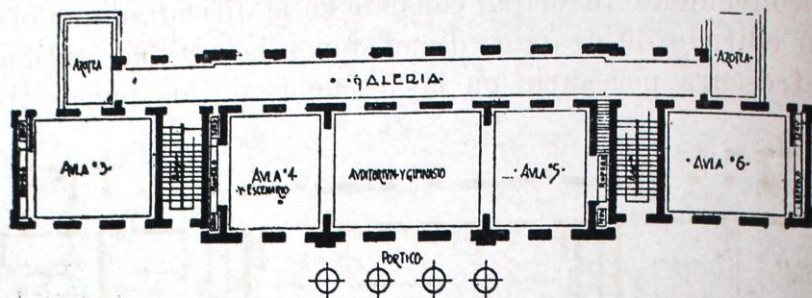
Plano de edificio para centro escolar. Tipo C. Planta alta.
